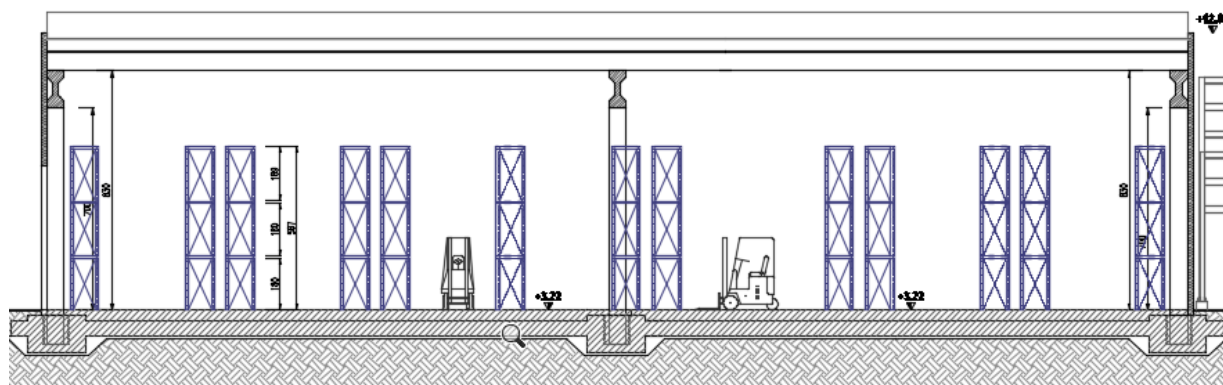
sezione trasversale capannone stoccaggio solido in colli (N7)
